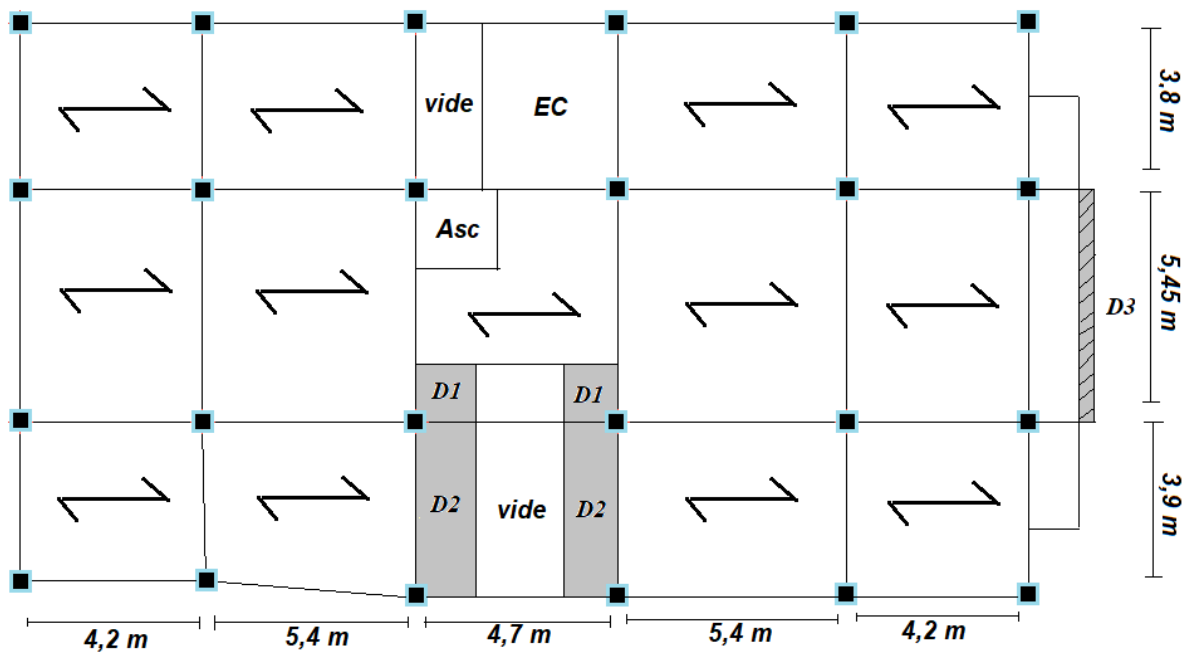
Schéma représentant les dalles pleines sur différents niveaux.
